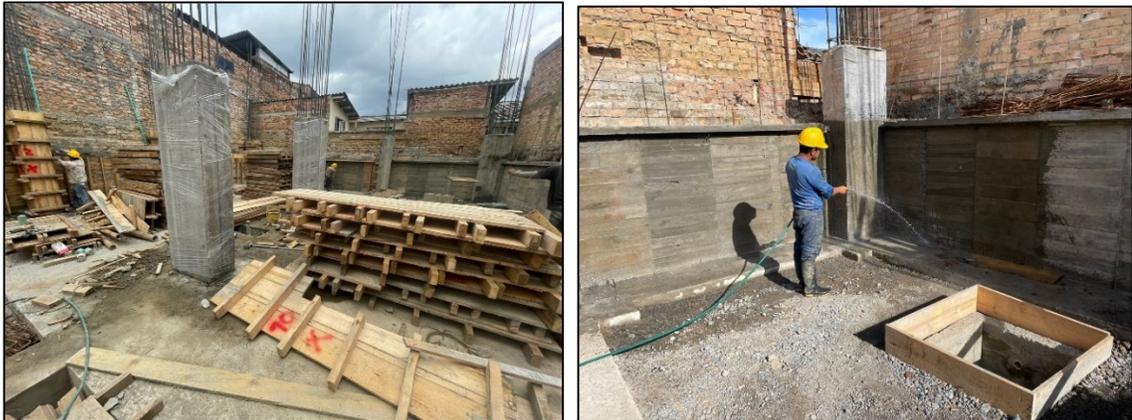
, Forrado y riego de agua a estructuras de concreto. Fuente: Elaboración propia.
